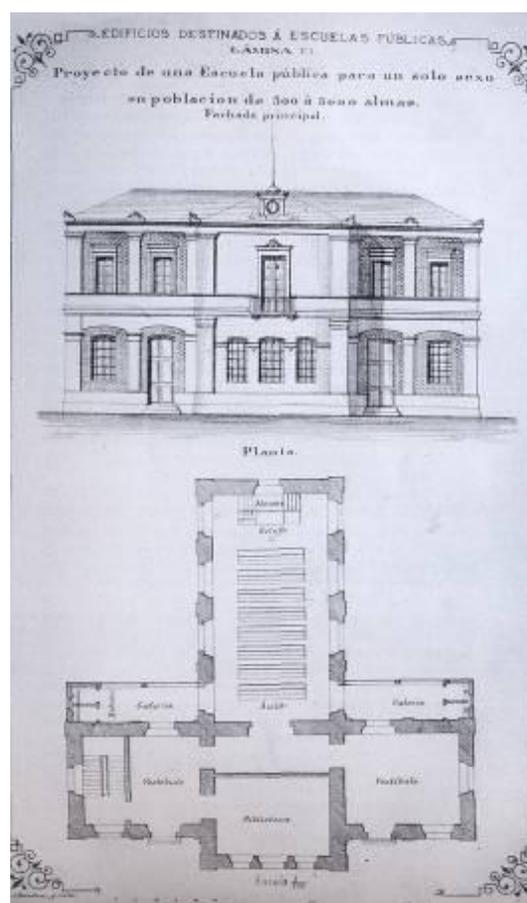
Planta e fachada de escola para 500 a 5000 almas
